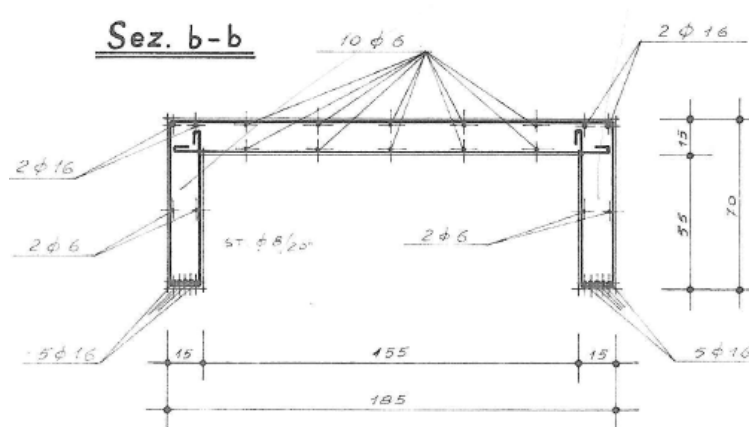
Trave del corridoio sopraelevato sul fronte principale
